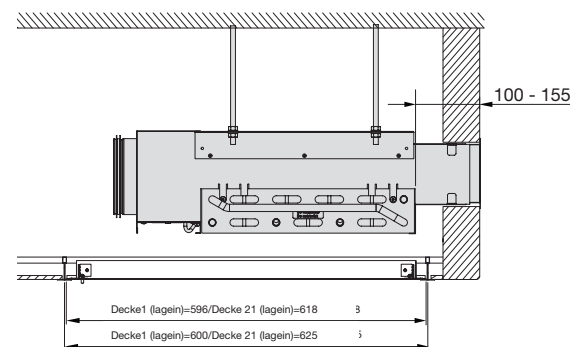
Montagezeichnung für Frontplatte -01/-21 mit äußeren Maßen.
